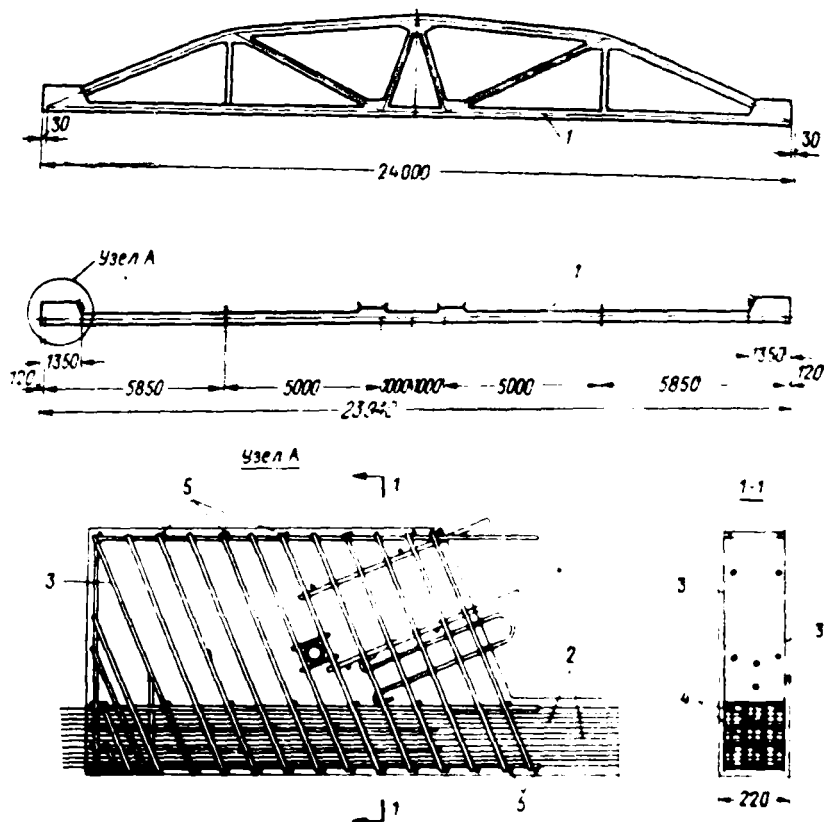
Первое решение арочной фермы с проволочной арматурой в отдельно изготавливаемом нижнем поясе
